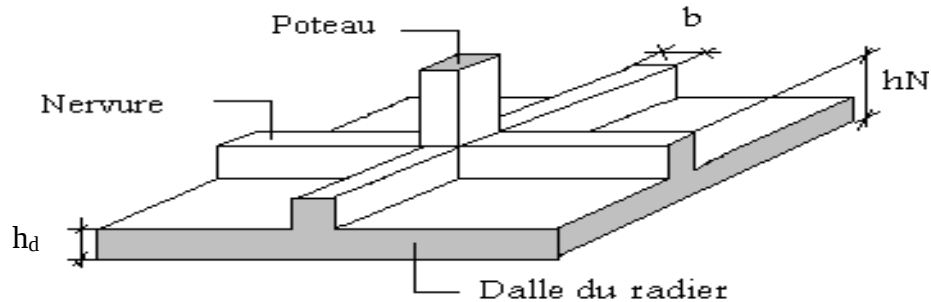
Disposition des nervures par rapport au radier et aux poteaux.
